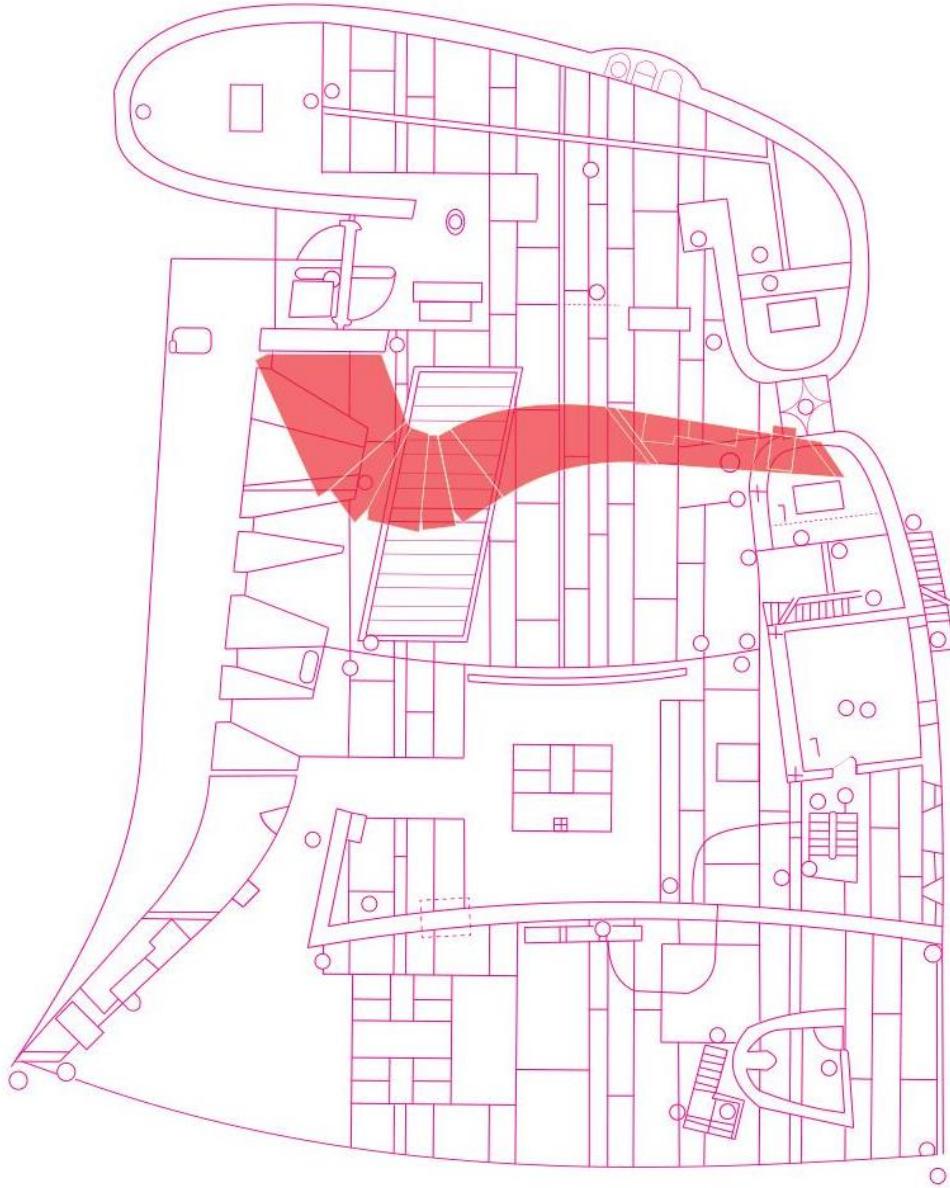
Planimetria con il muro sud virtuale assimilabile ad un jobel.
